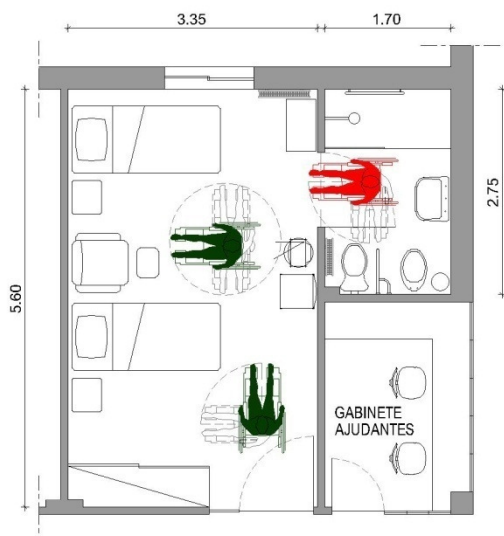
Quarto e banheiro privado - 2º pavimento.
